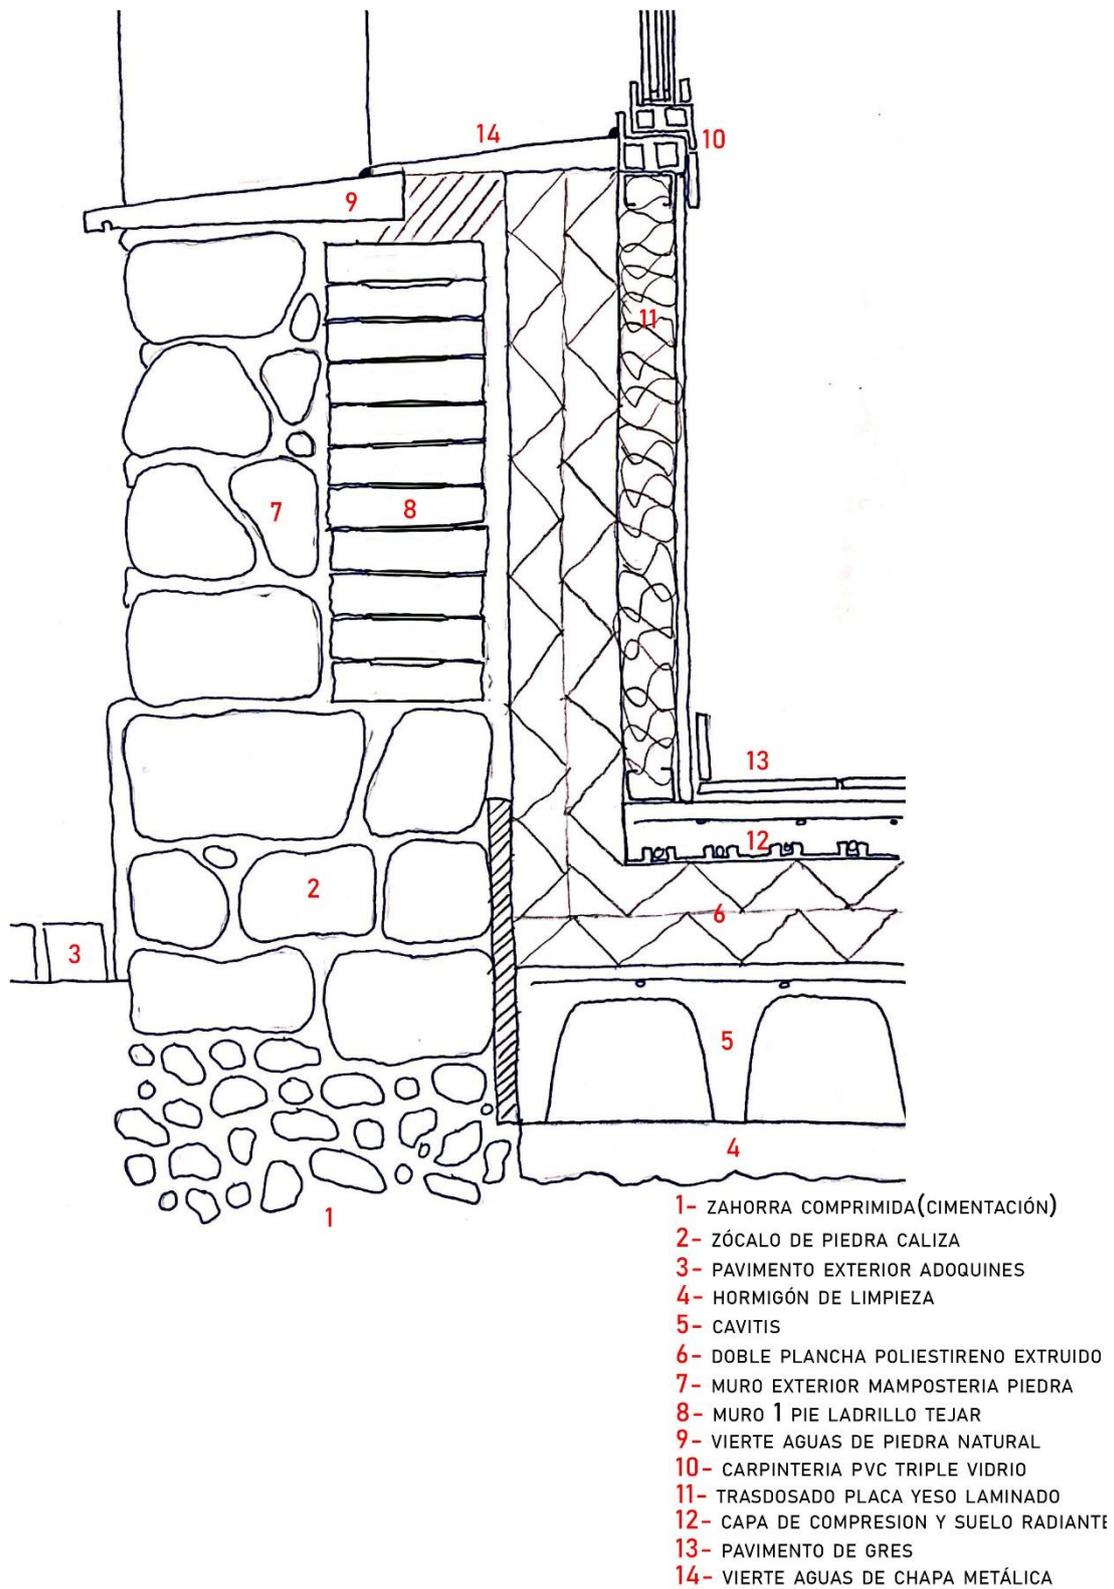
Detalle constructivo reformado – Cimentación – Arranque de la fachada – Huevo inferior
